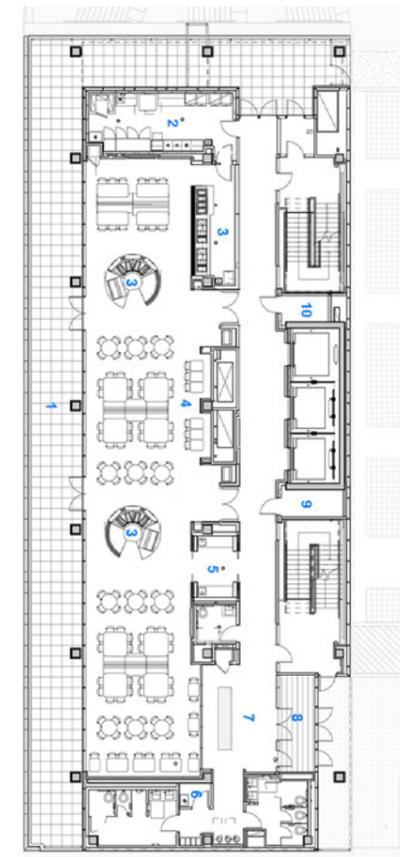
+ Abb.29 Schnitt und Grundriss
